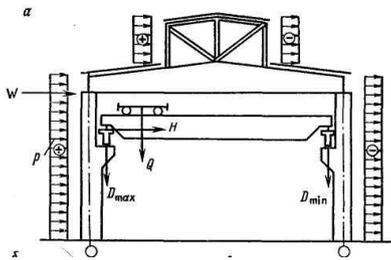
Расчетно-конструктивная схема поперечной рамы
